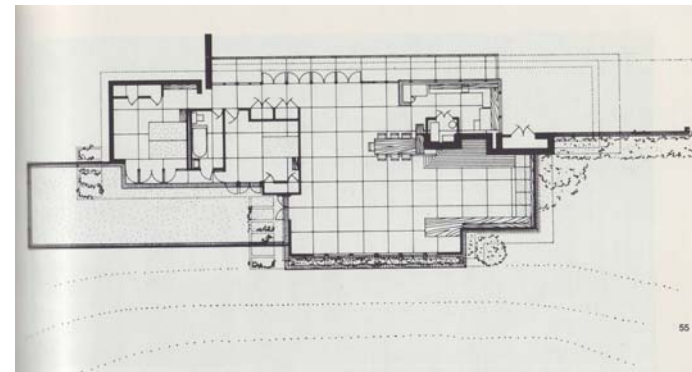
Grundriss (Sergeant 1984, 55)
